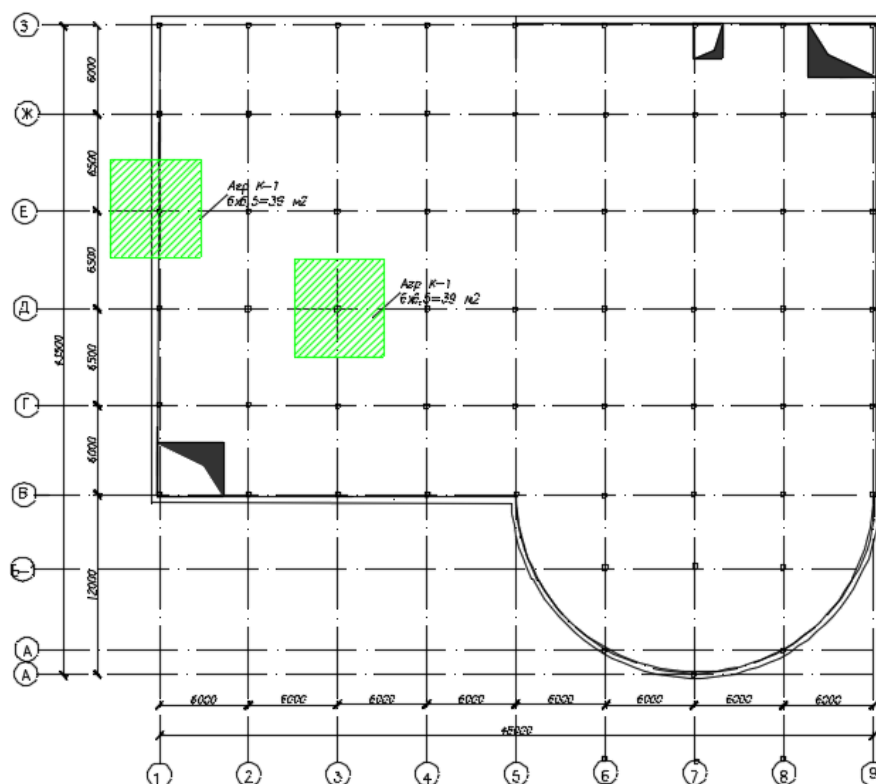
Грузовая площадь наиболее нагруженной средней колонны и центральной колонны
